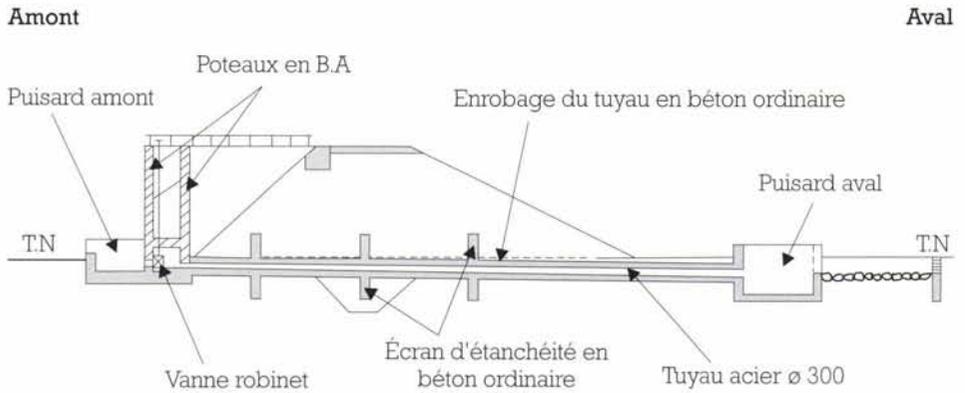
Ouvrage de prise avec tour (Katiéplénou - COTE D'IVOIRE - Extrait de [2]).
